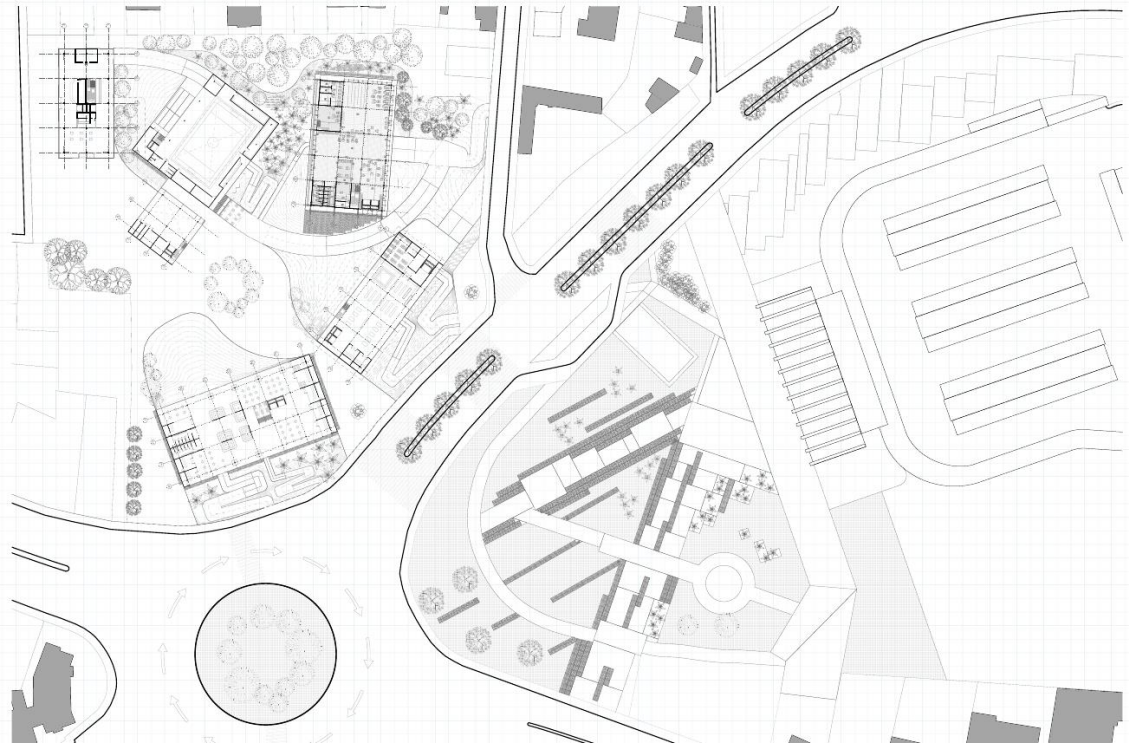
Intervención urbanística y paisajística, Fuente: Elaboración propia
